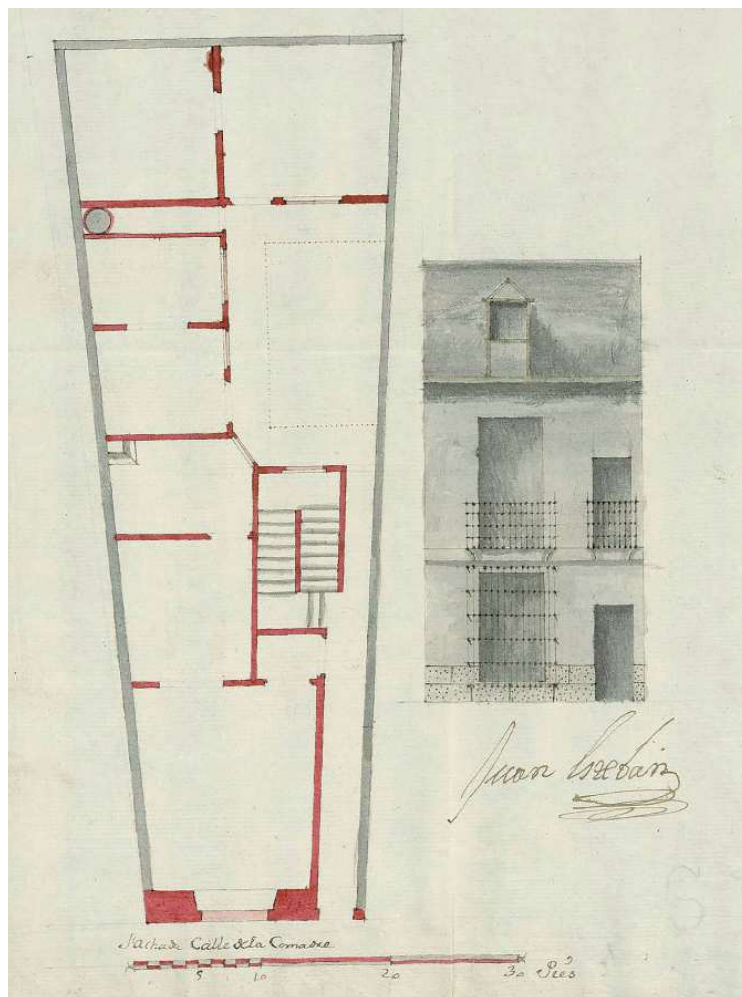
Planta y alzado construidos en c/ Comadre (1751-AVM:1-84-148).
